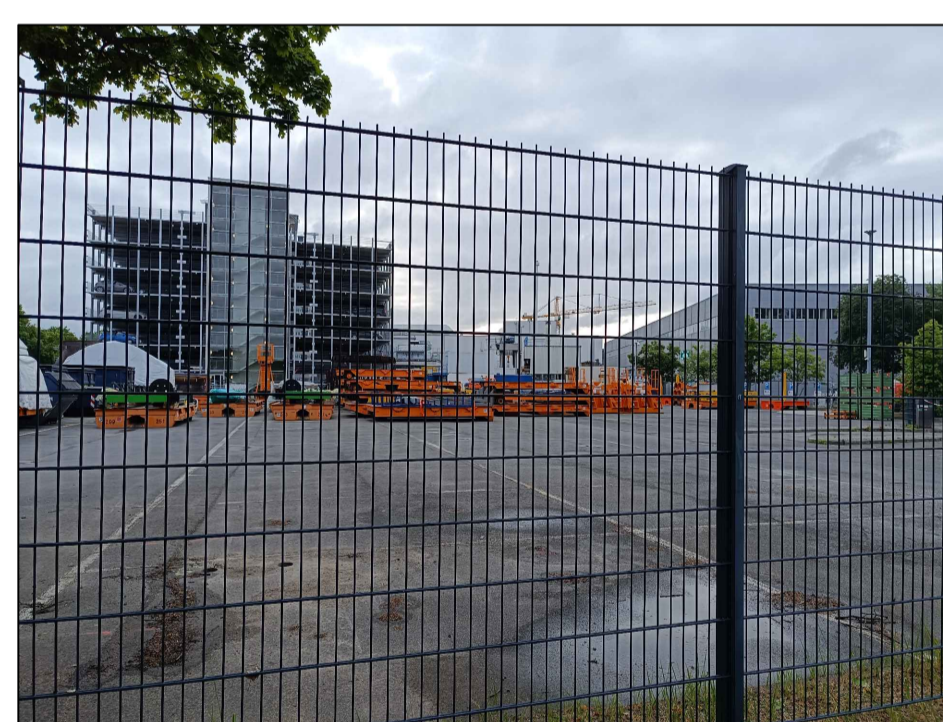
Wiebestraße, Blick Richtung Osten auf Plangebiet
